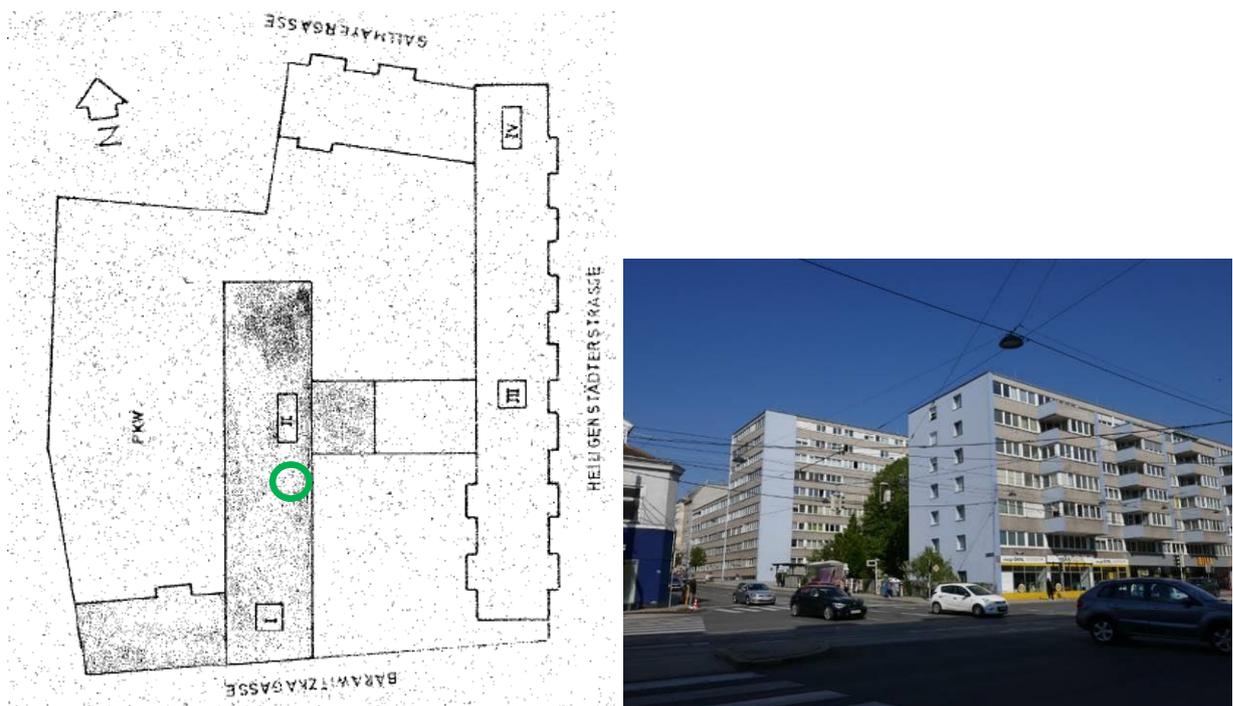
Lageplan o. M. mit Lage der Wohnung (grüner Kreis); Quelle: Bestandsplan Dezember 1971
